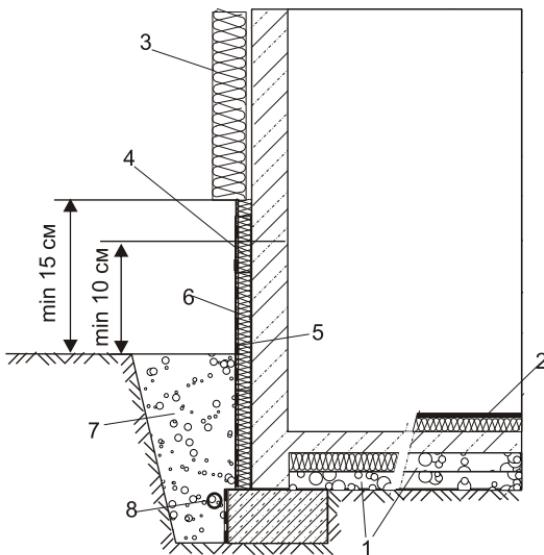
Утепление внешних стен фундамента с утепленным полом по грунту: 1 — щебеночная подготовка; 2 — конструкция пола; 3 — утепление наружной стены; 4, 5 — утеплитель; 6 — гидроизоляция; 7 — кольцевой дренаж (трубы перфорированные); 8 — песочно-гравийная смесь или песок
